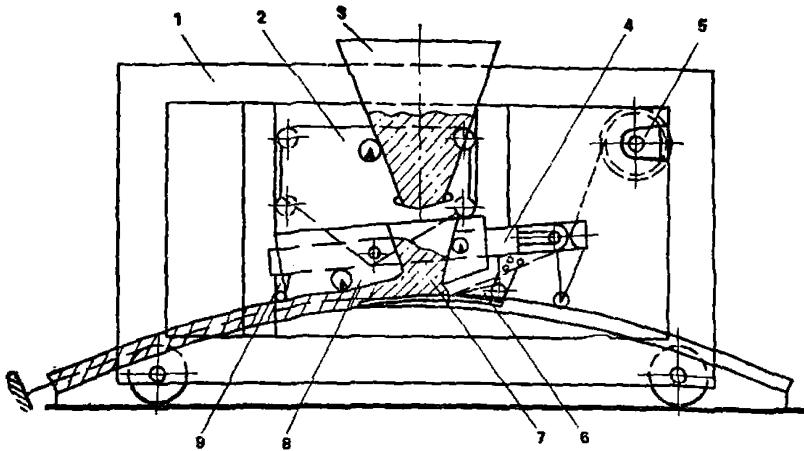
Схема формования армоцементных плит-оболочек сводов
